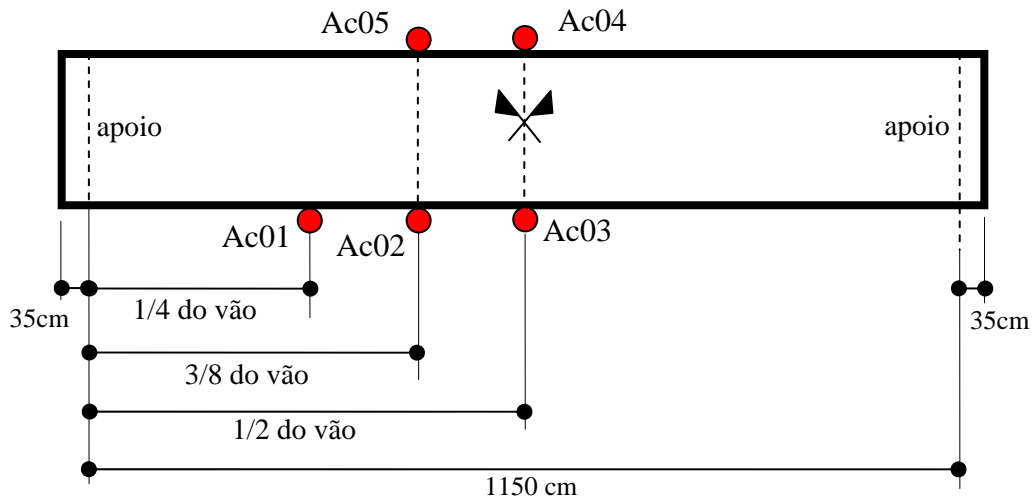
Disposição em planta dos acelerômetros na passarela.
